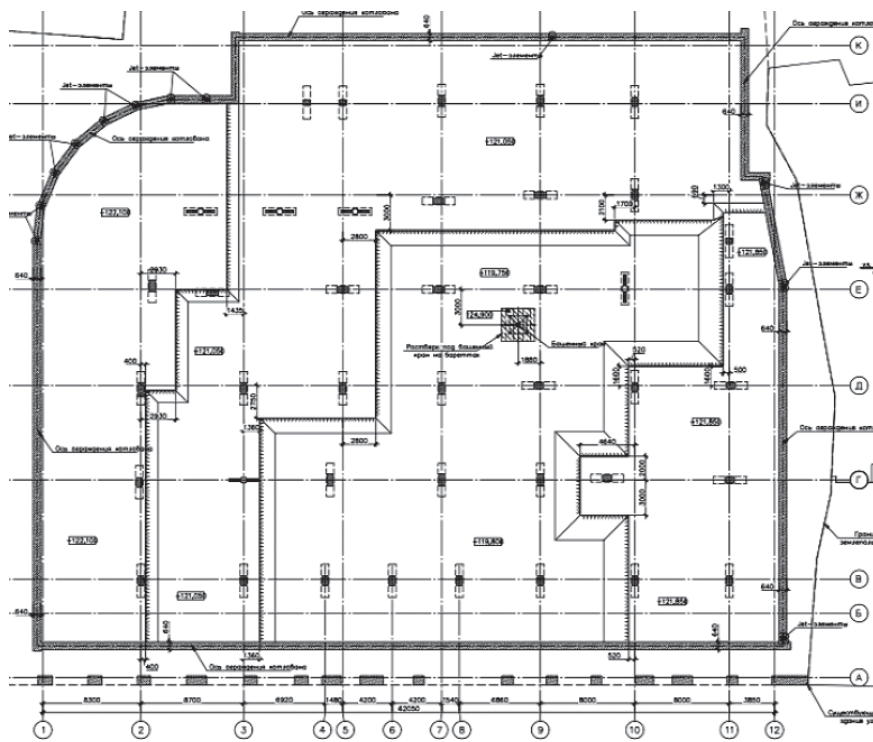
Этапы устройства ограждающей конструкции, свай-баретт и экскавации котлована под защитой бетонитового раствора
